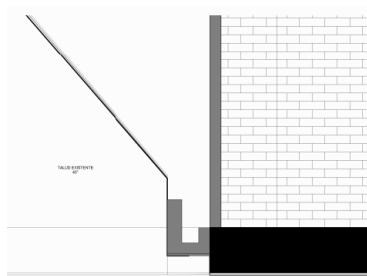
Detalle canaleta aguas lluvias del talud existente.
